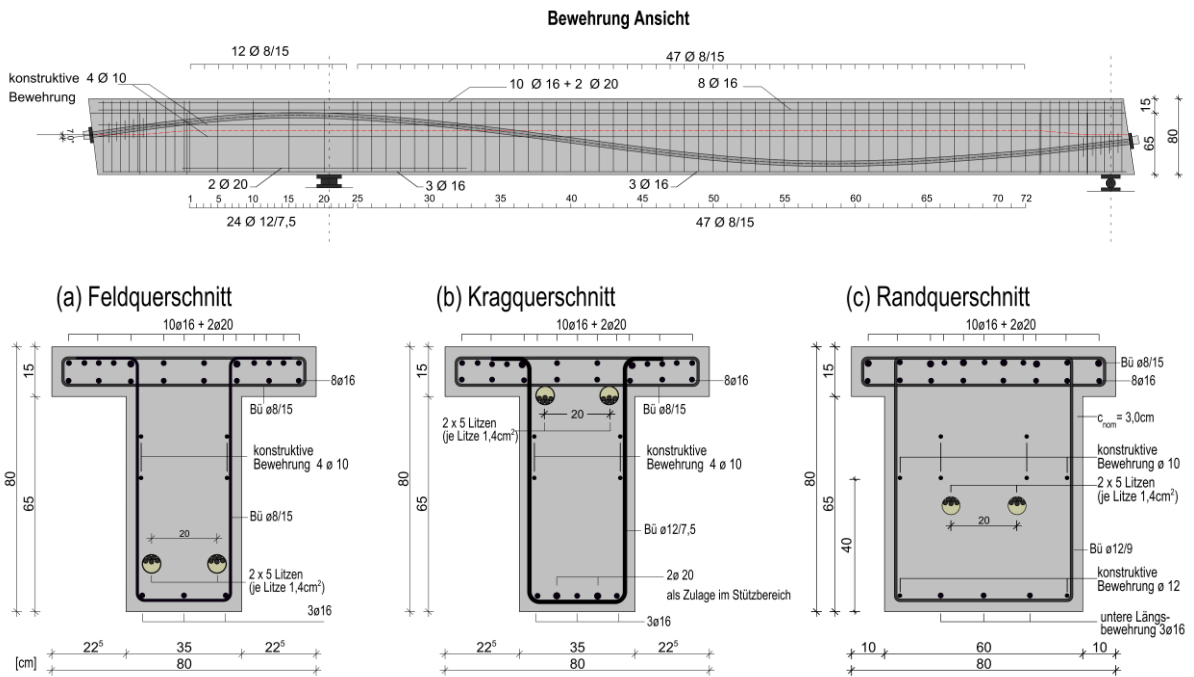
Bewehrungsplan Versuchsträger ETK2
